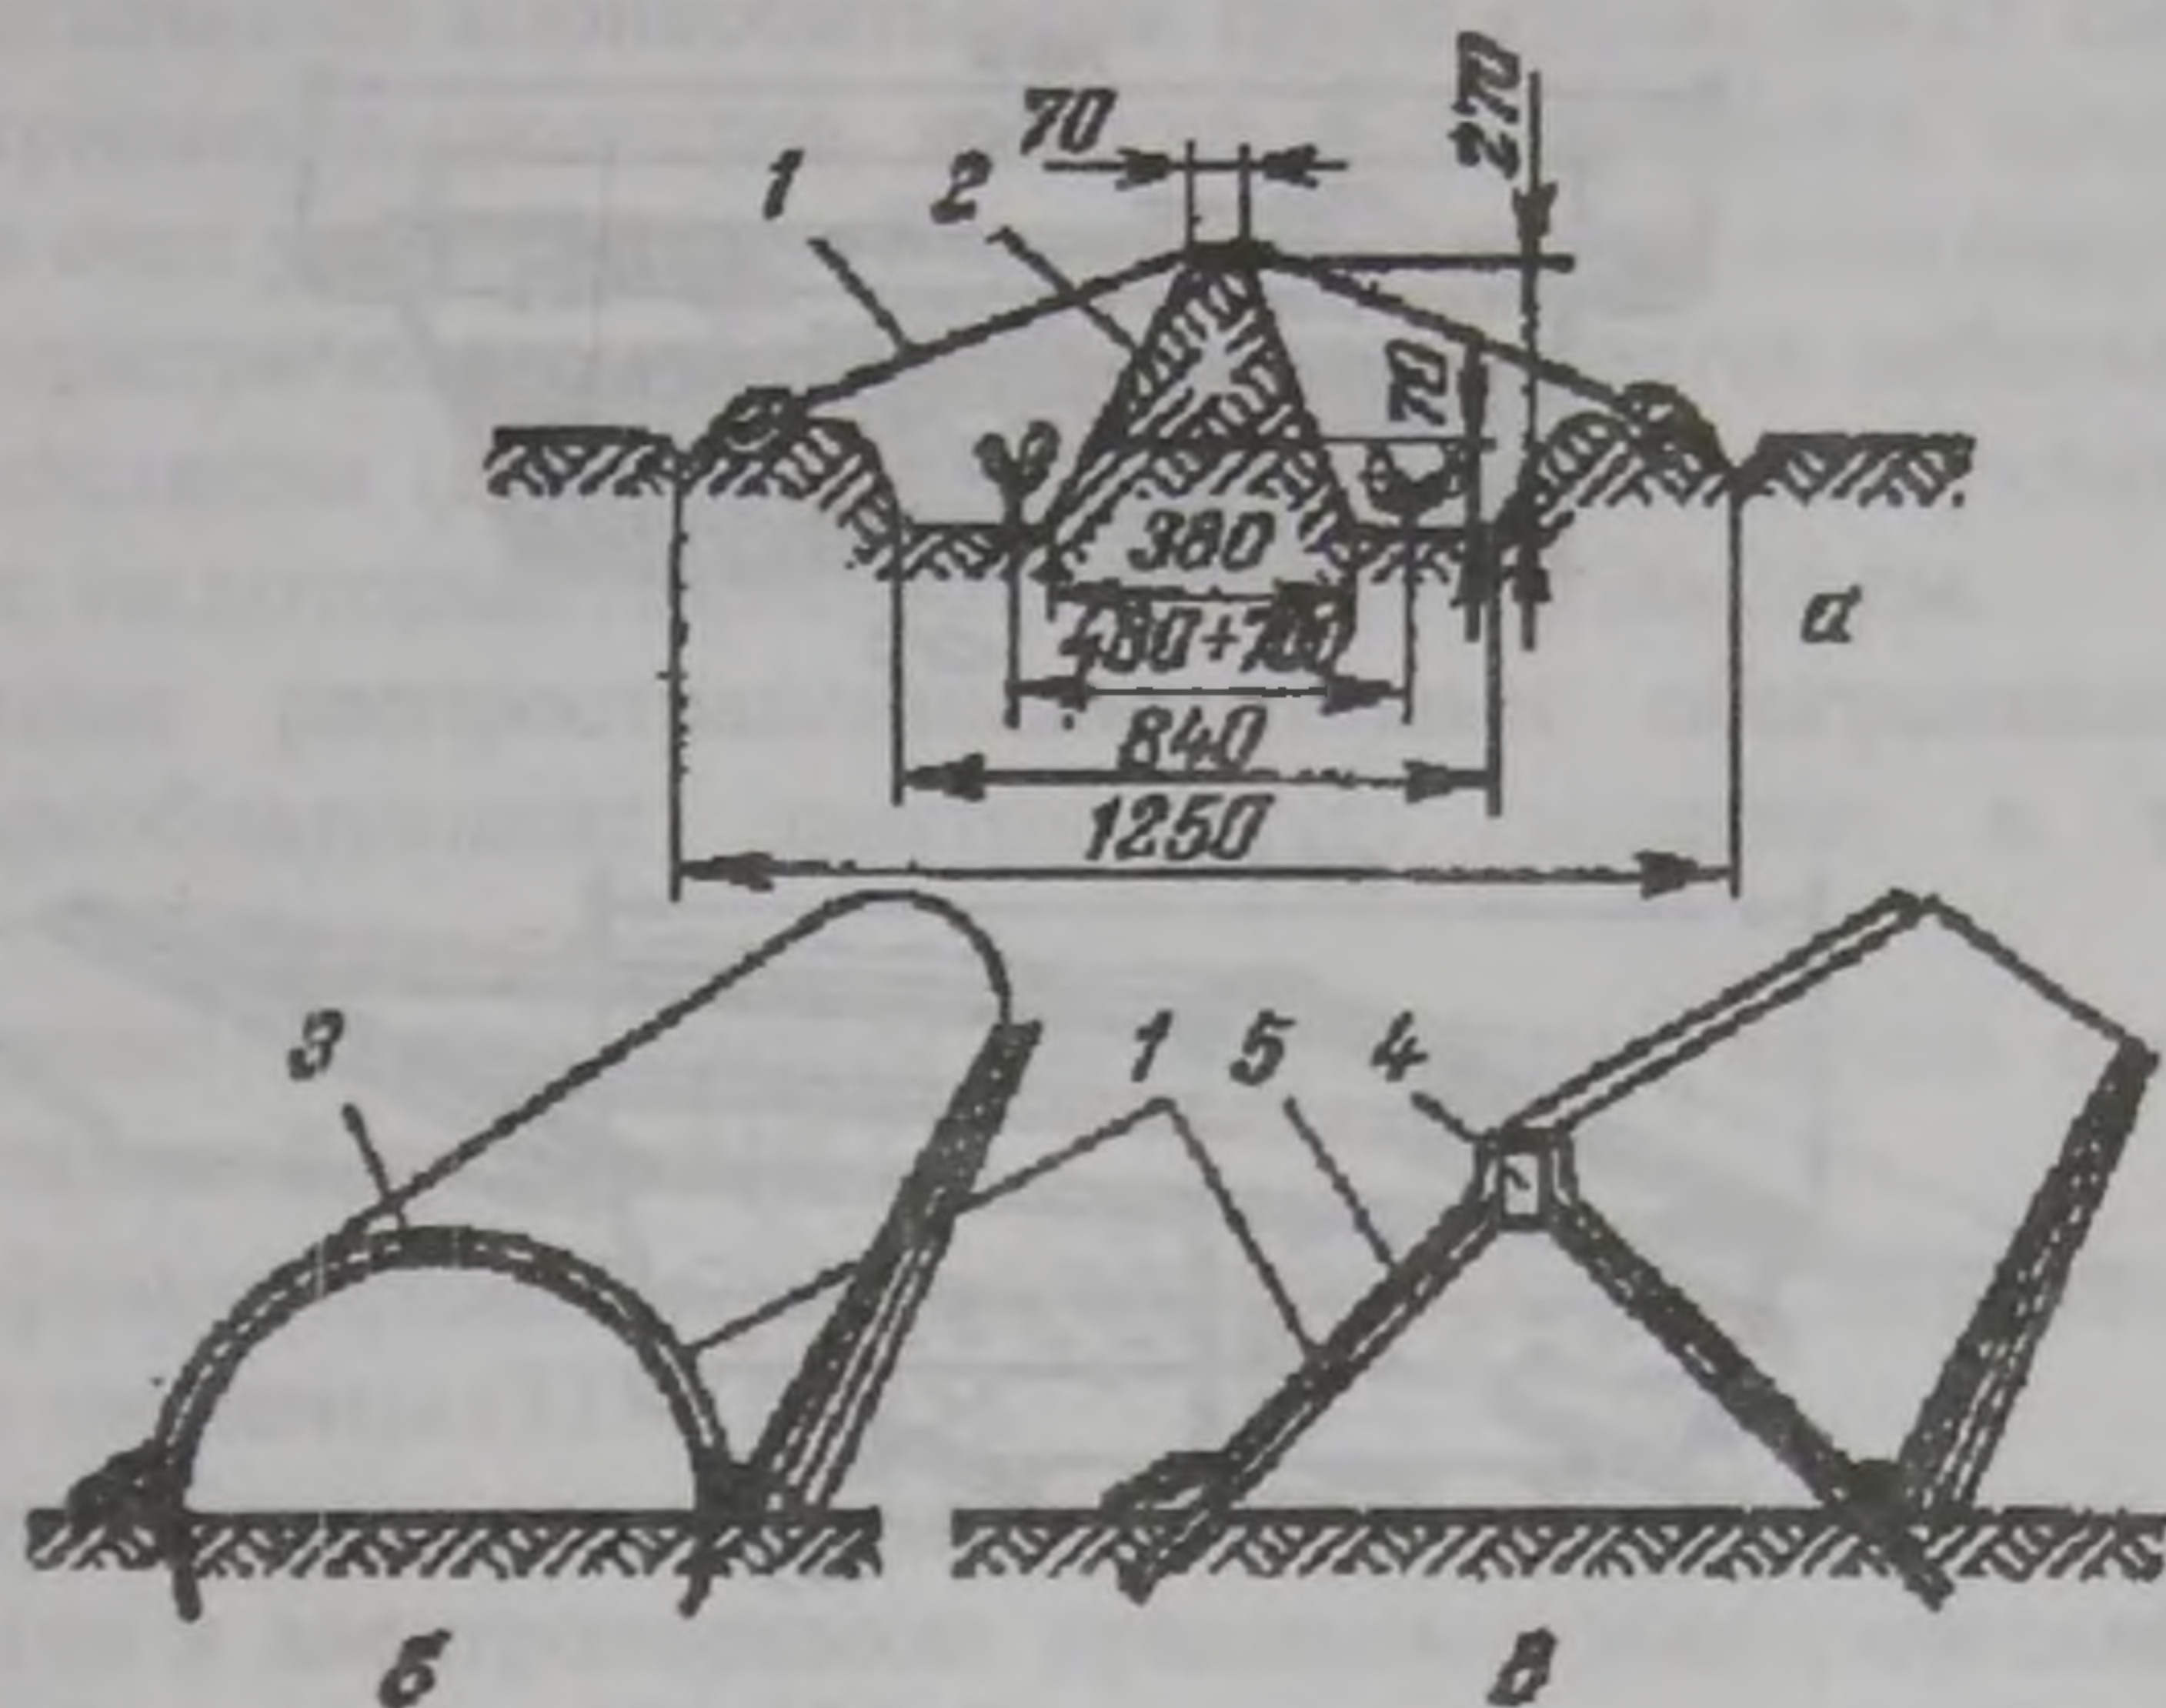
Бескаркасный (а), тоннельный (б), шатровый (в) типы укрытий из пленки (в разрезе): 1- пленка; 2- валик из земли; 3- дуга каркаса тоннеля; 4- коньковый брус; 5- стропильные опоры (размеры в миллиметрах)
